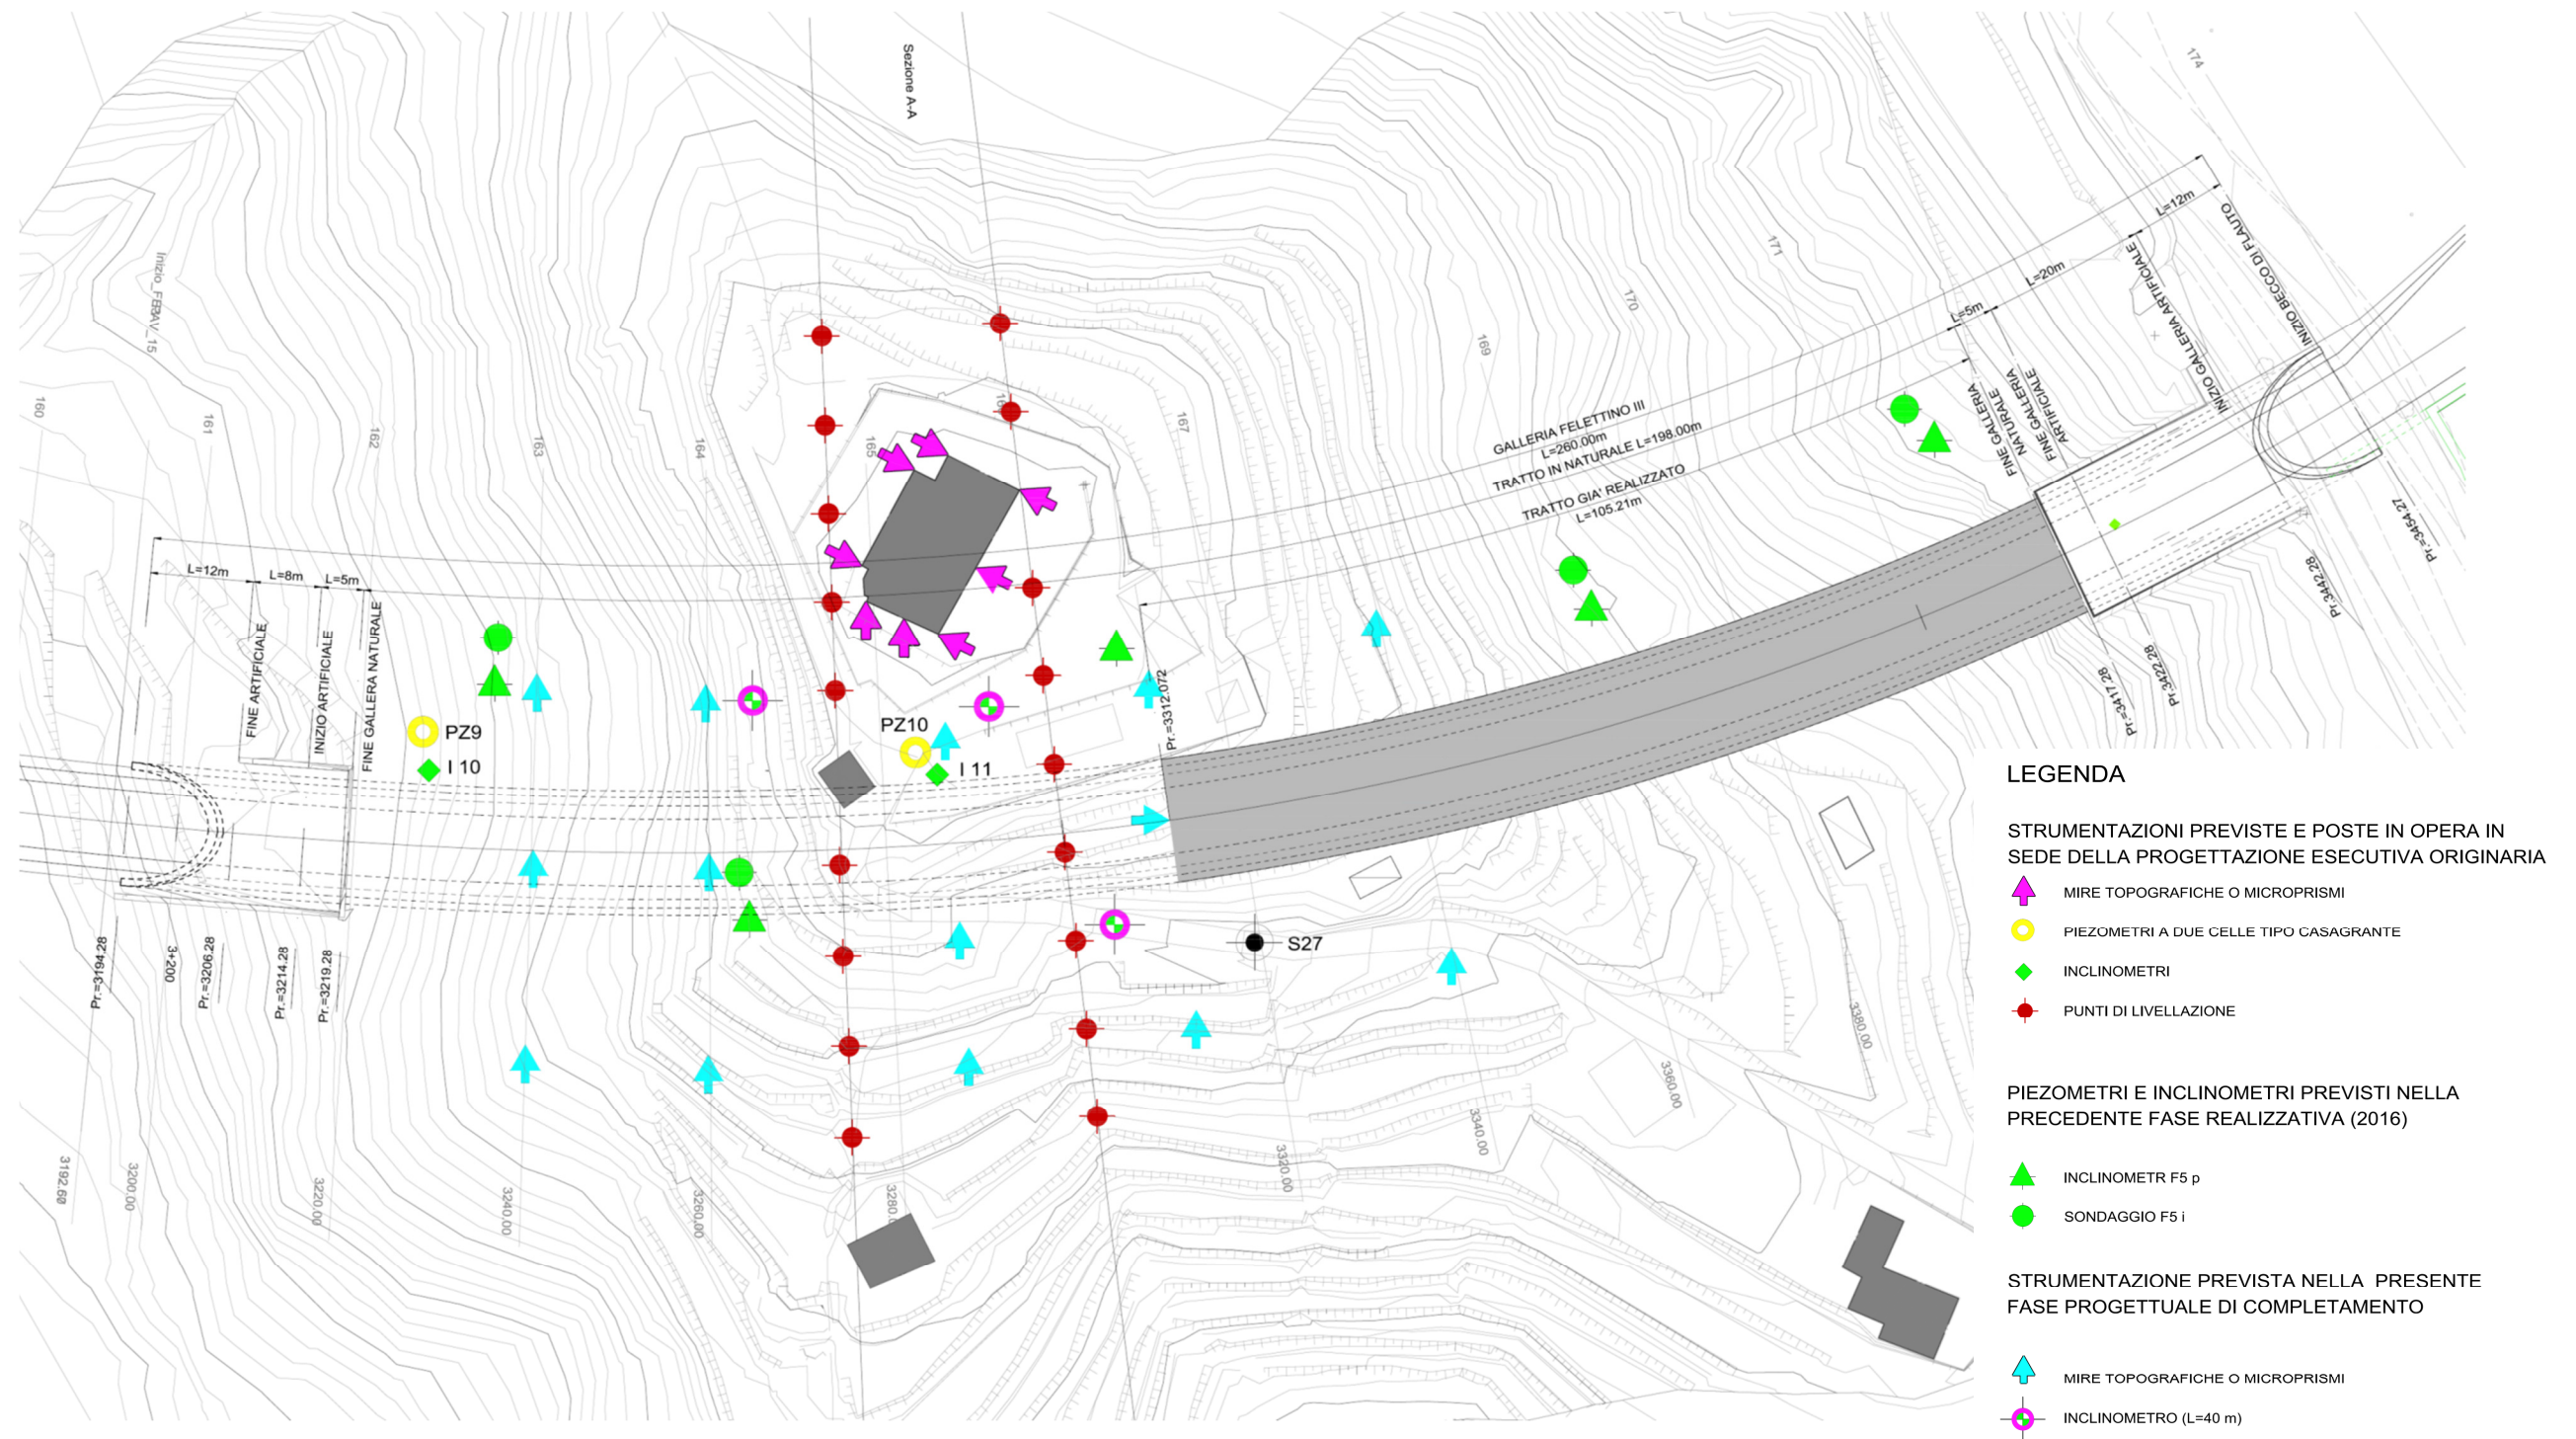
Sistemi di monitoraggio – Stralcio planimetrico
